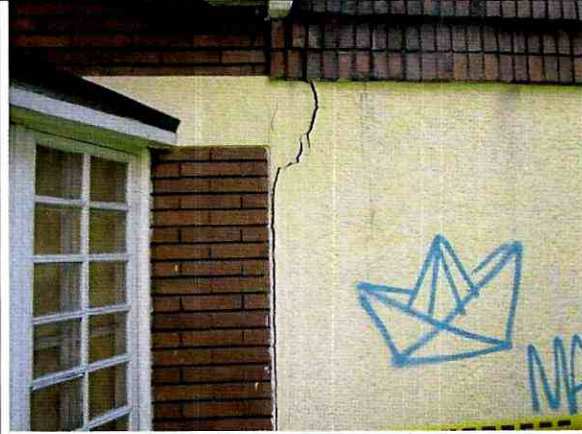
Grieta vertical en muro de fachada y cerramiento.
